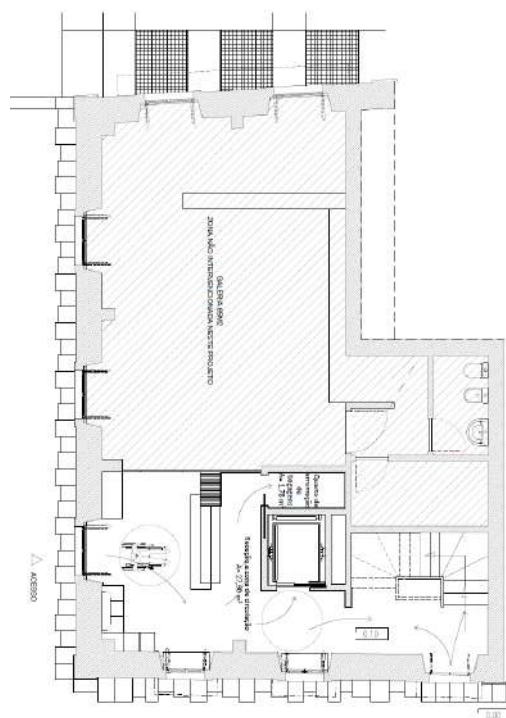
Planta de Zonamento e Circulação - Piso 0
